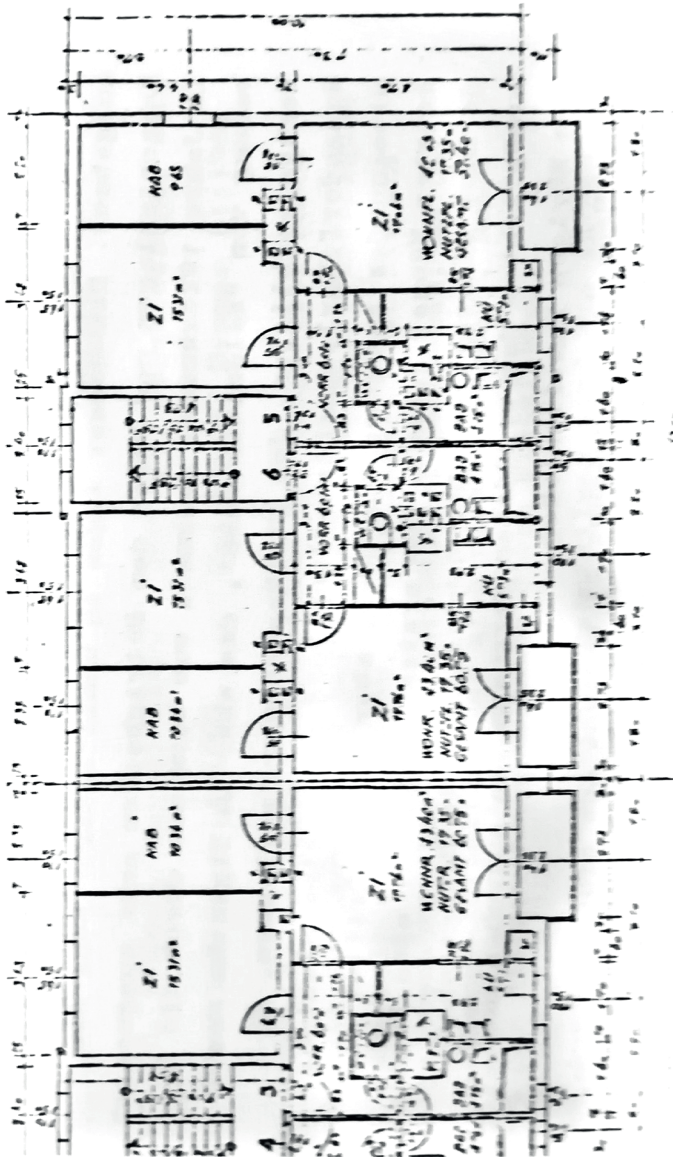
Bergdirektion Fohnsdorf, Auerlingstraße im Bereich 71-81, Grundriss Erdgeschoss
